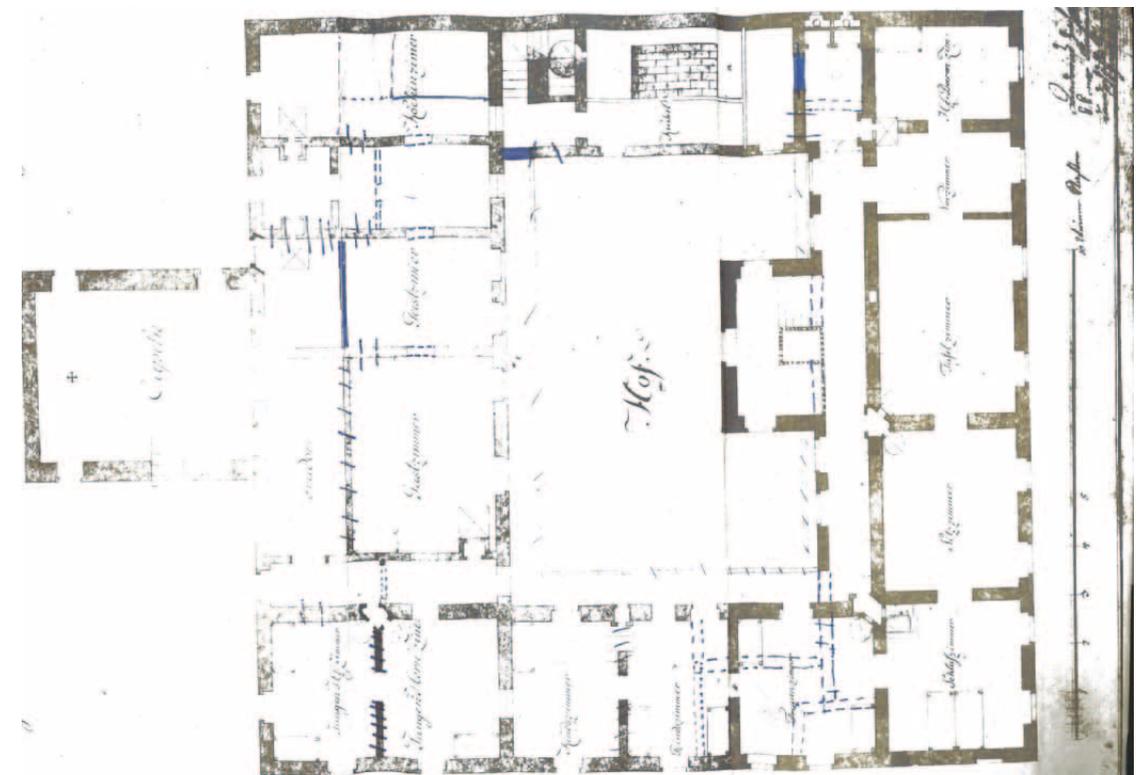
Kopie des Entwurfsplans, Obergeschoß, Andreas Zach, 1796, mit im 20. Jahrhundert händisch eingetragenen, nicht durchgeführten Umbauten.
